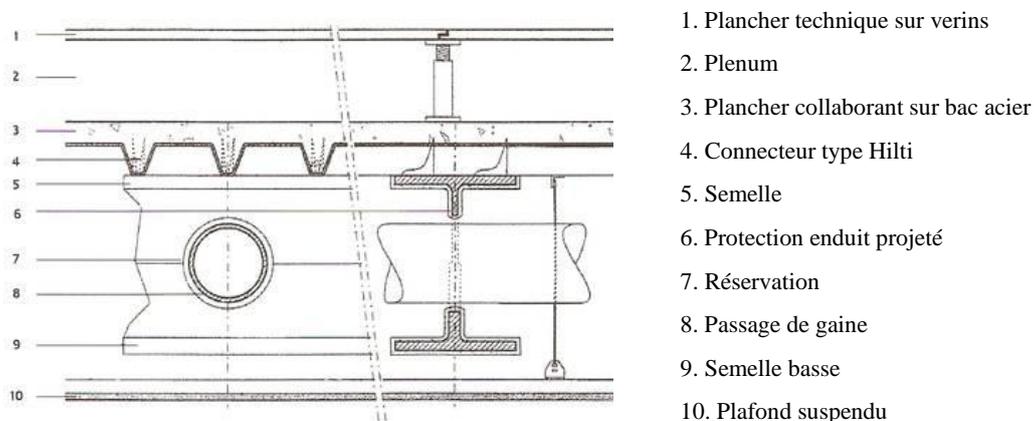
Coupe de principe sur un plancher collaborant avec faux plafonds/
